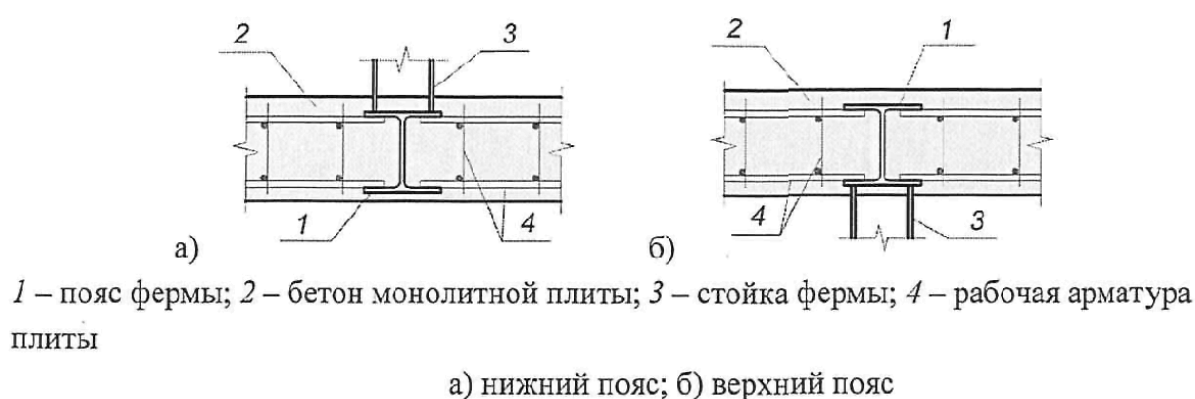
Схема узла сопряжения монолитного перекрытия по инвентарной опалубке с поясами ферм
